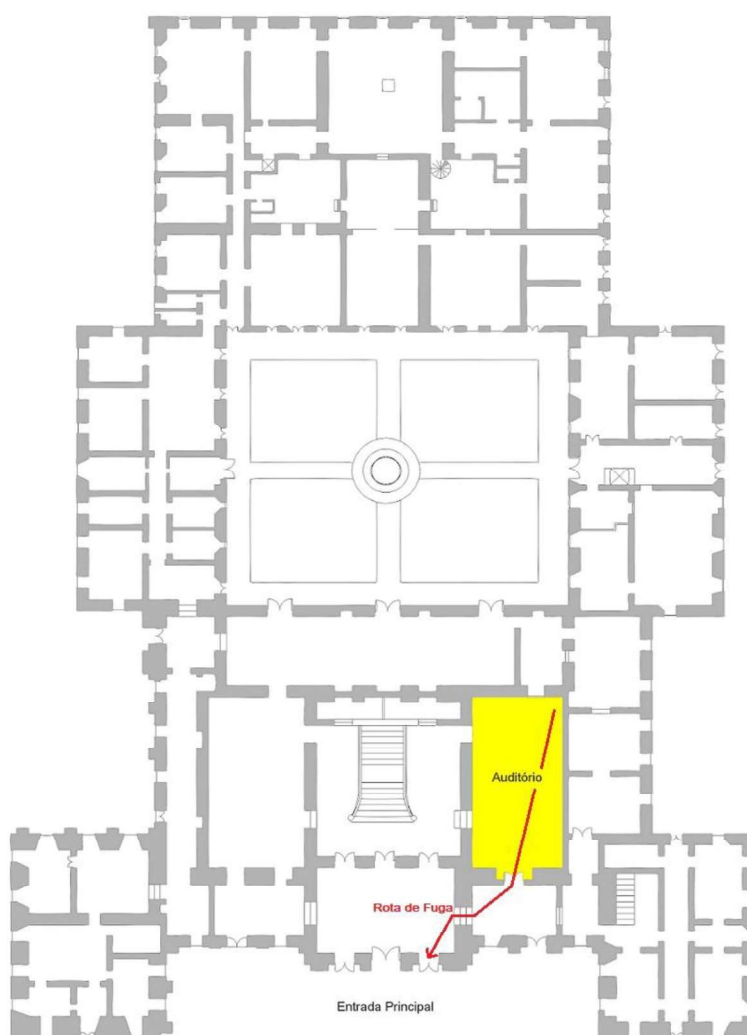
Croqui do pavimento térreo e local de origem do incêndio (auditório).
